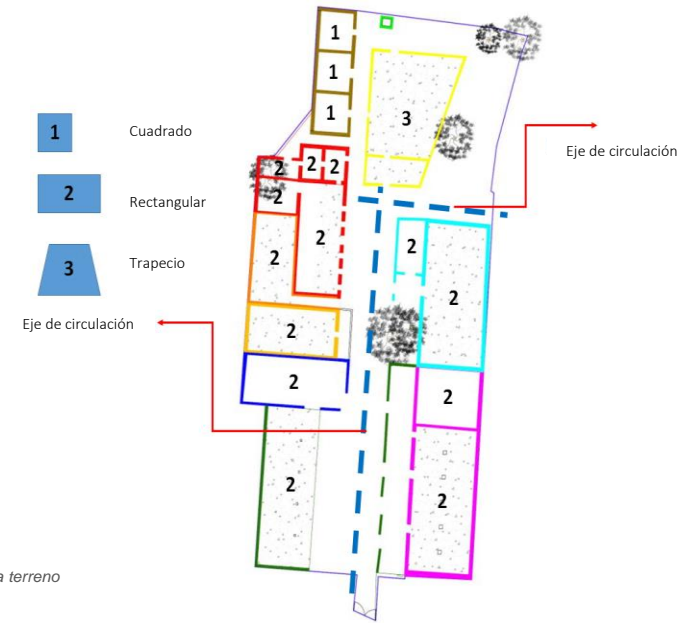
Planta con ejes y ángulo de avenida Lázaro Cárdenas hacia terreno de la Hacienda Cusi.
